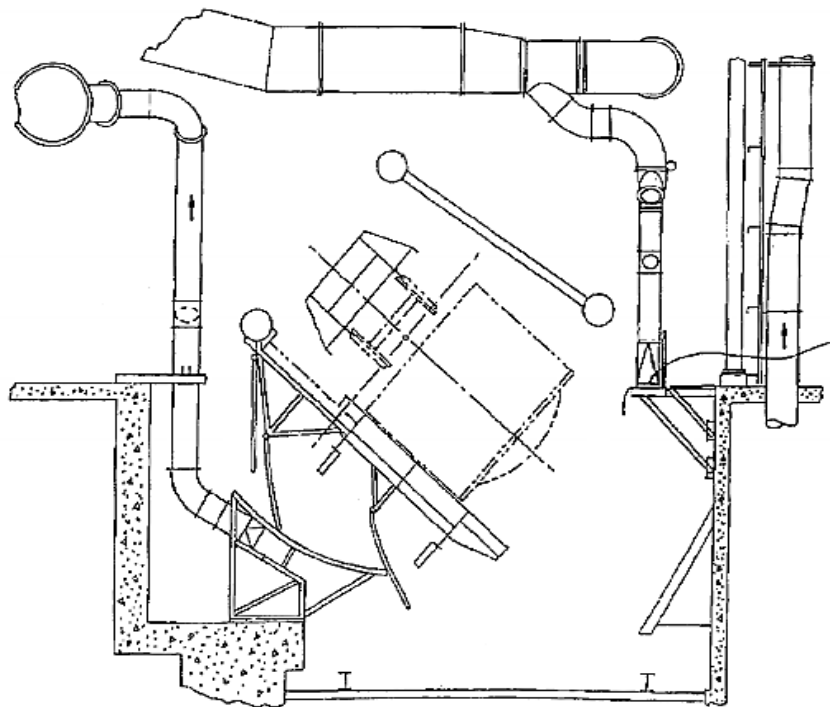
Способ пылеулавливания при разгрузке вагоноопрокидывателя
